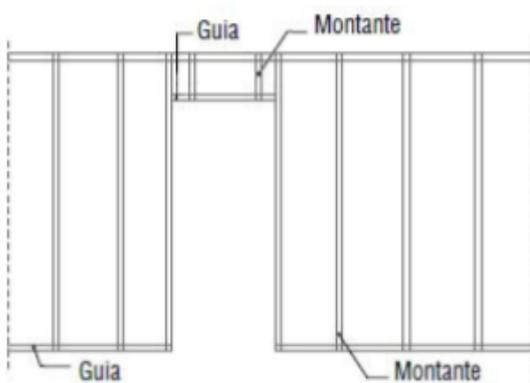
Estrutura do sistema de *drywall*. Fonte: Knauf (2013)
